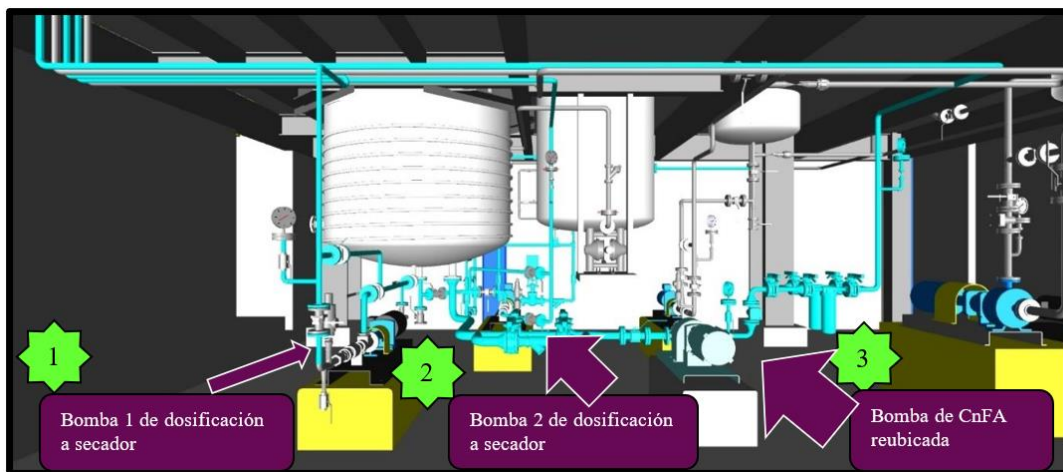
Vista frontal de la planta baja de cuarto de ácidos
